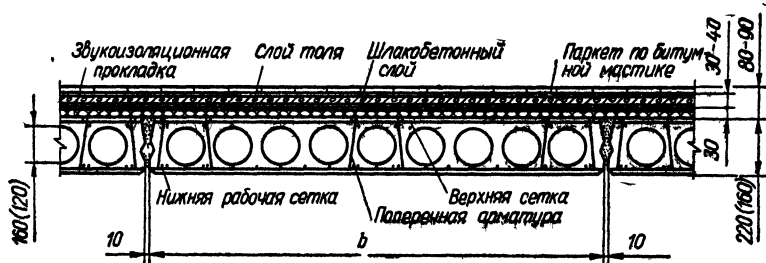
Многопустотные панели с круглыми отверстиями, армированные сварными сетками.
